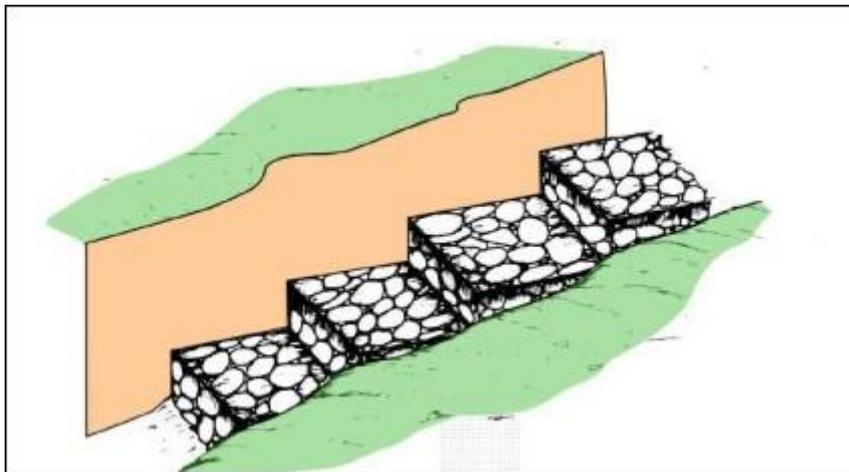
Protección del lecho de la quebrada con muros escalonados (andenes), utilizando bloques de roca o concreto armado.
